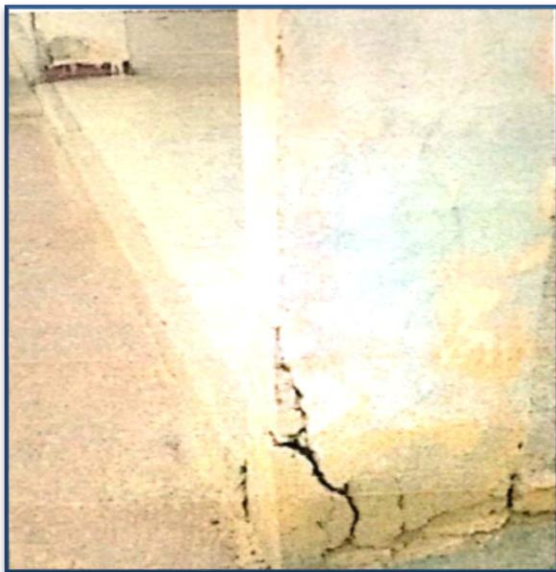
Dégradation du béton à la base d'un poteau et corrosion des armatures. [44]
